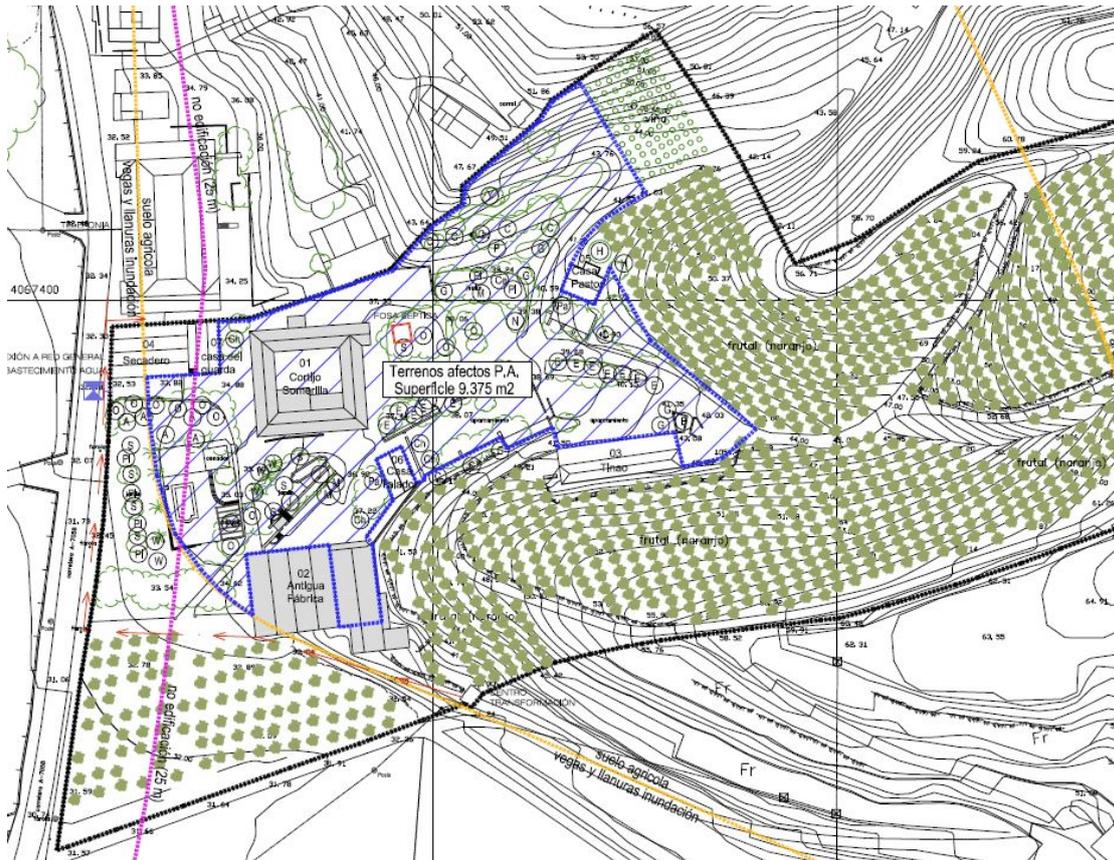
Imagen del plano 2, mostrando el ámbito de los terrenos vinculados a la actuación de interés público
